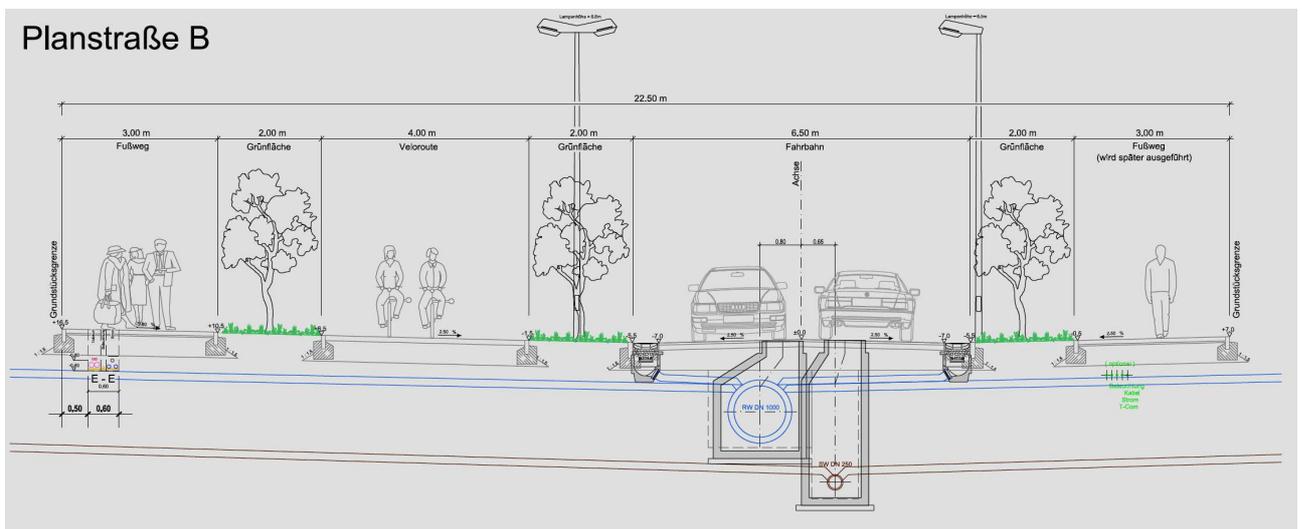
Bit Consult GmbH, Friezheimer Straße 3, 70499 Stuttgart: Ausschnitt aus der Ausführungsplanung zur Erschließung „Wohnpark Am Ebenberg“, Plan: Regelquerschnitt, Stand 04.03.2011
